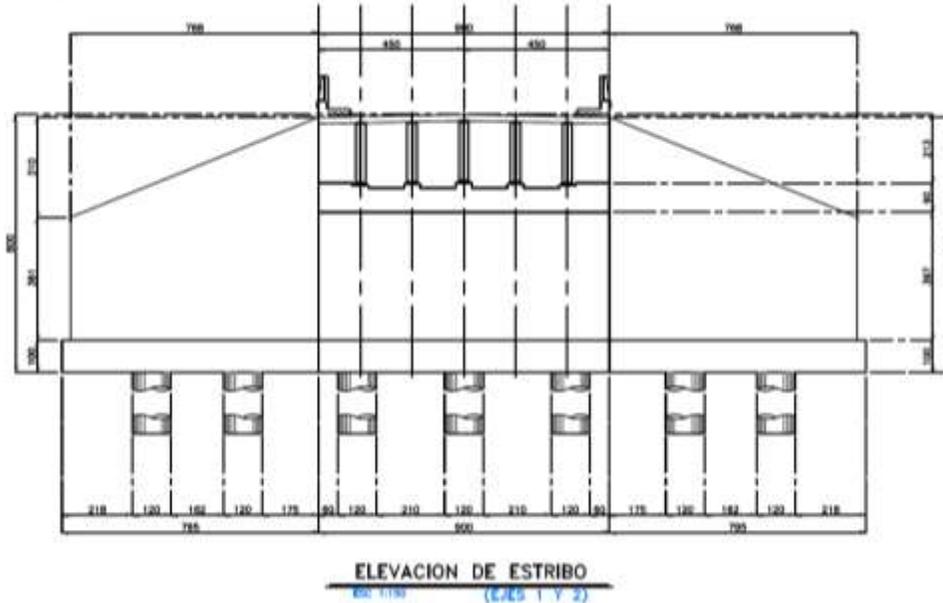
Elevación de estribo en el cual se nota las medidas de los aleros.
